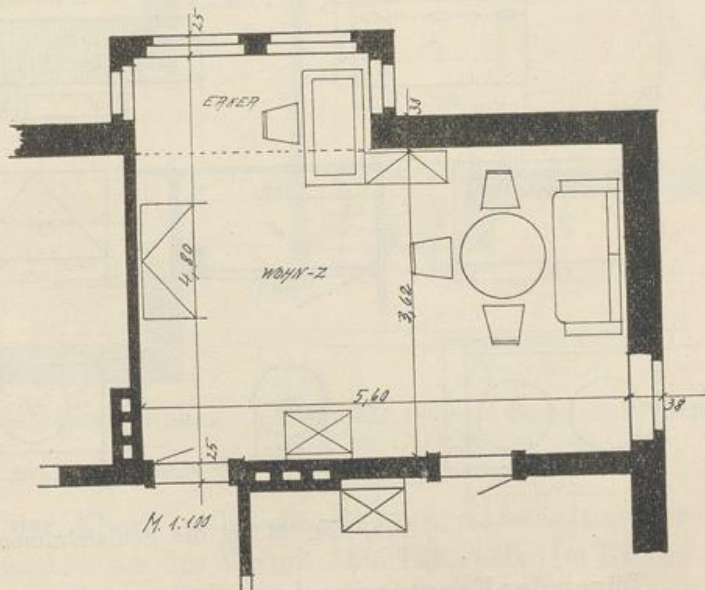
Wohnzimmer mit Erkervorbau zur Vergrößerung der Grundfläche des Raumes.
